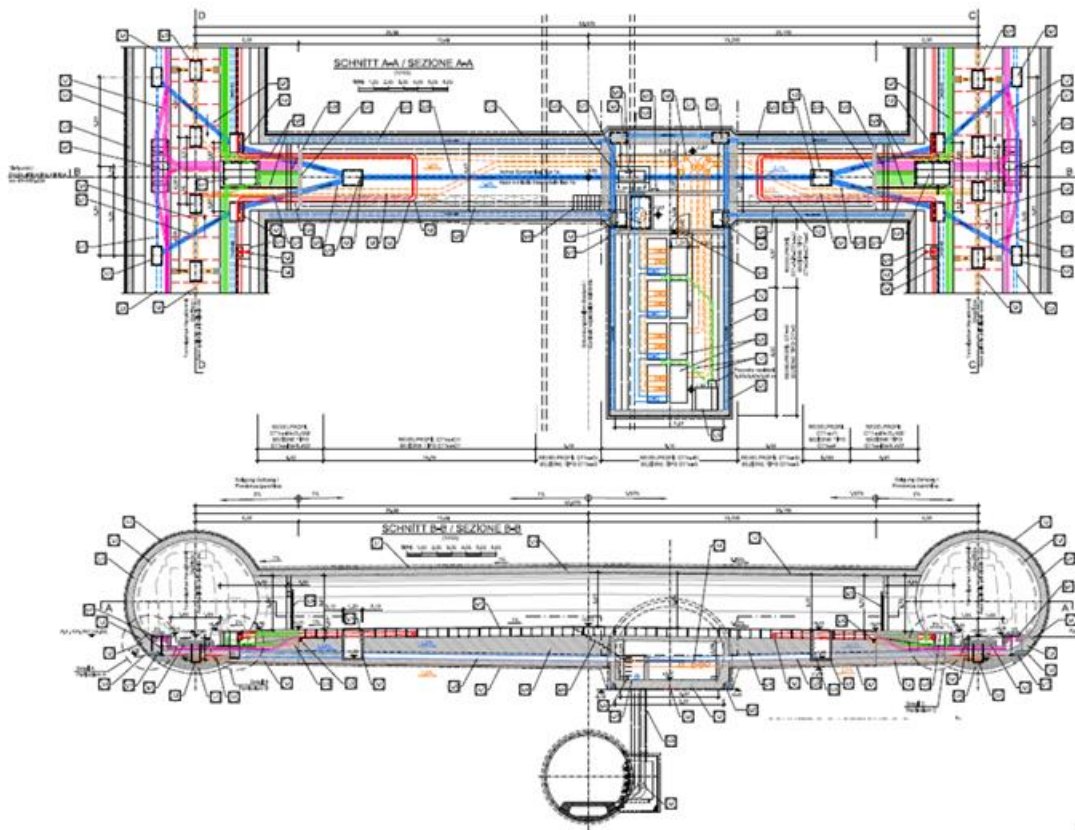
Querstollen 49/2 Tiefpunkt - Grundriss und Längsquerschnitt [91].
